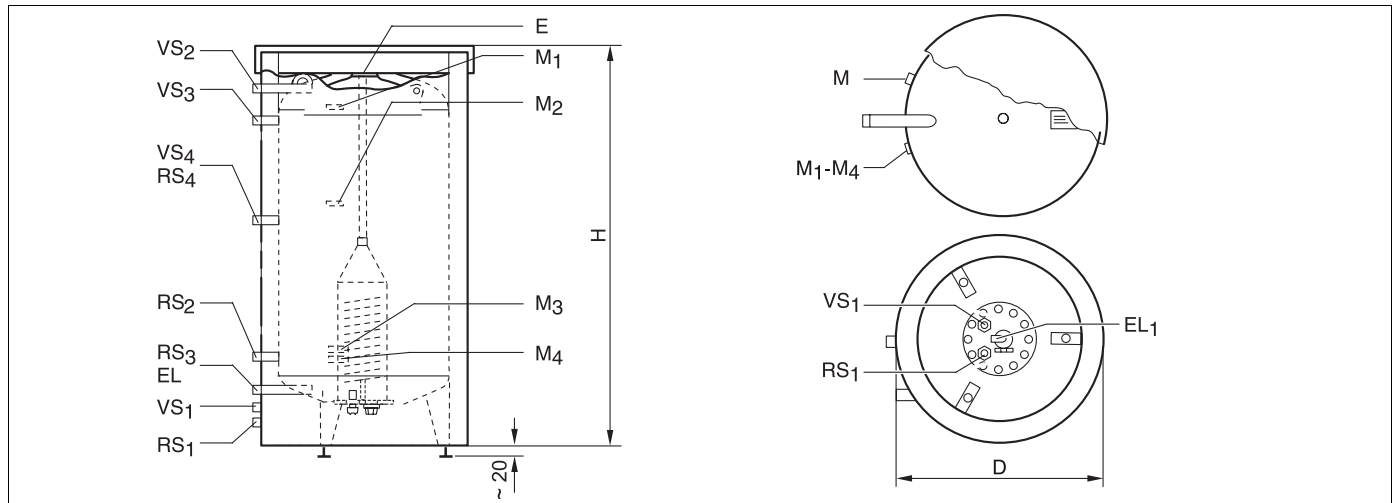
Abmessungen und Anschlüsse (Maße in mm)
